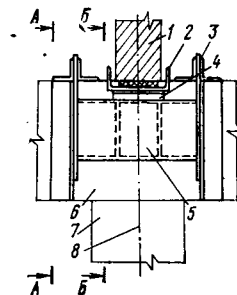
Страховочное приспособление (вид со стороны пролета):
